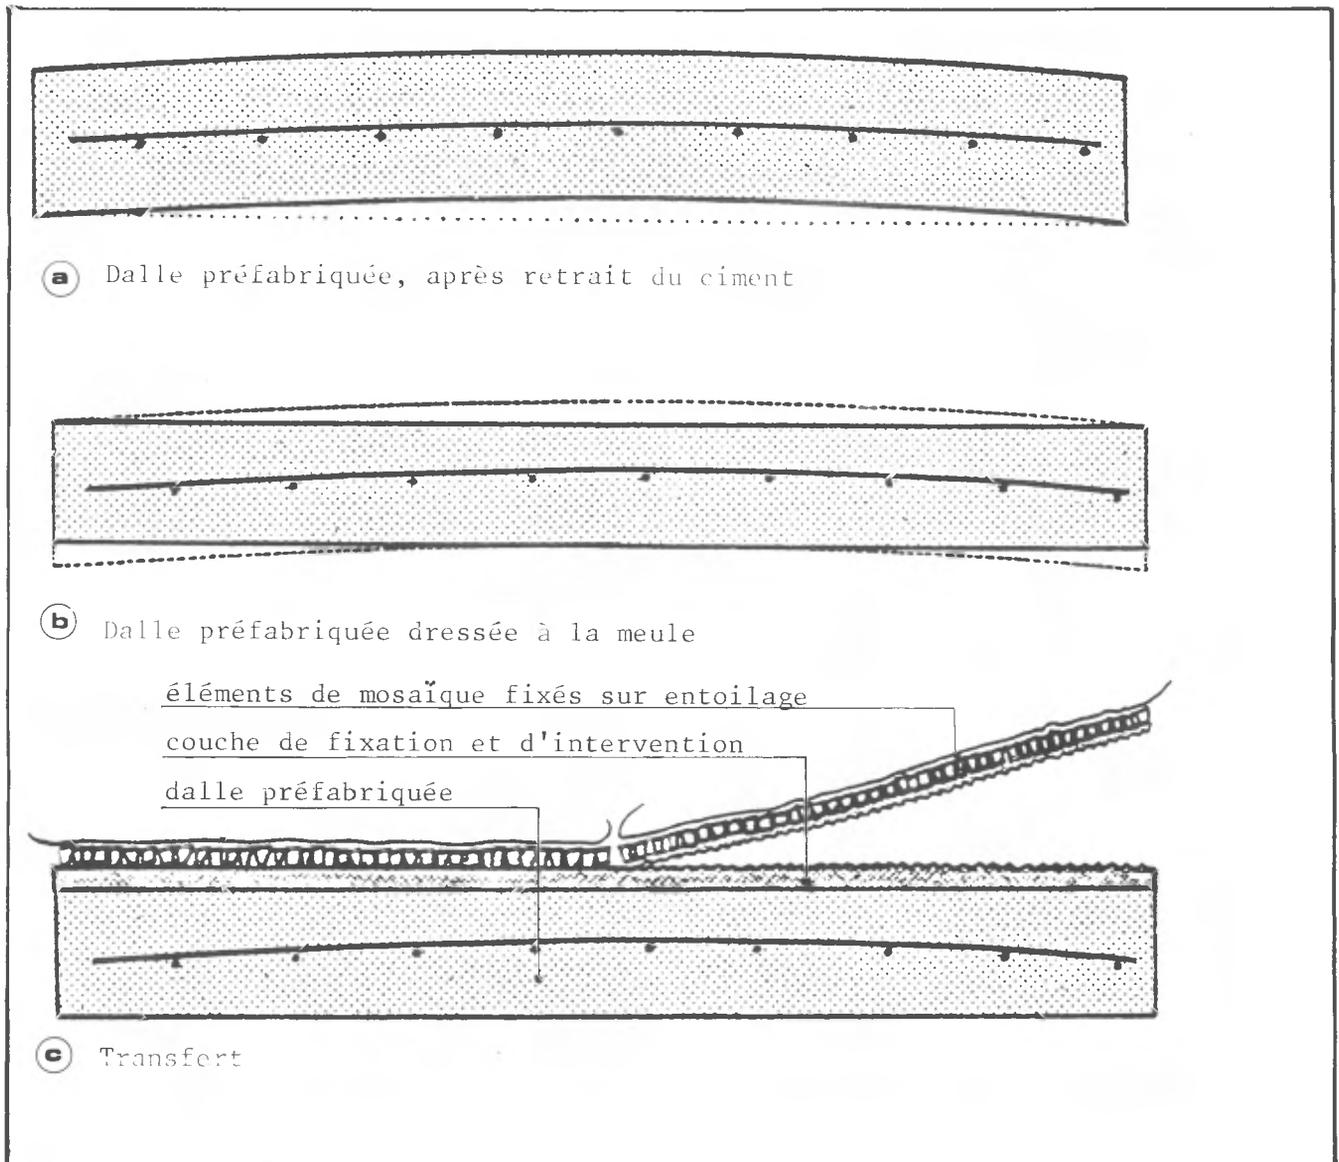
Transfert sur dalle de béton de ciment armé préfabriquée avec couche d'intervention.
